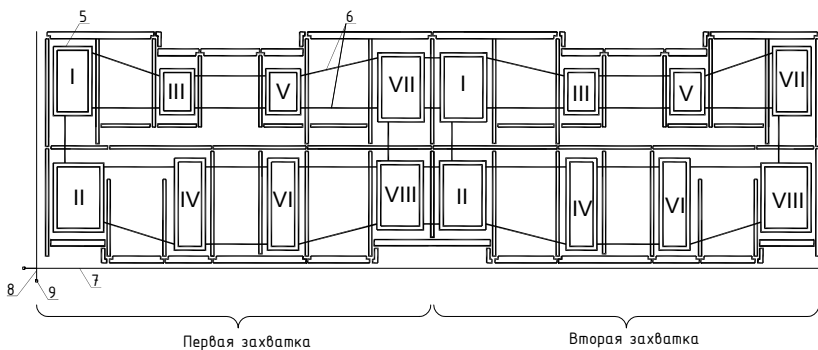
Схема монтажа панельного здания с применением групповой монтажной оснастки «Индикатор 12-16»:
